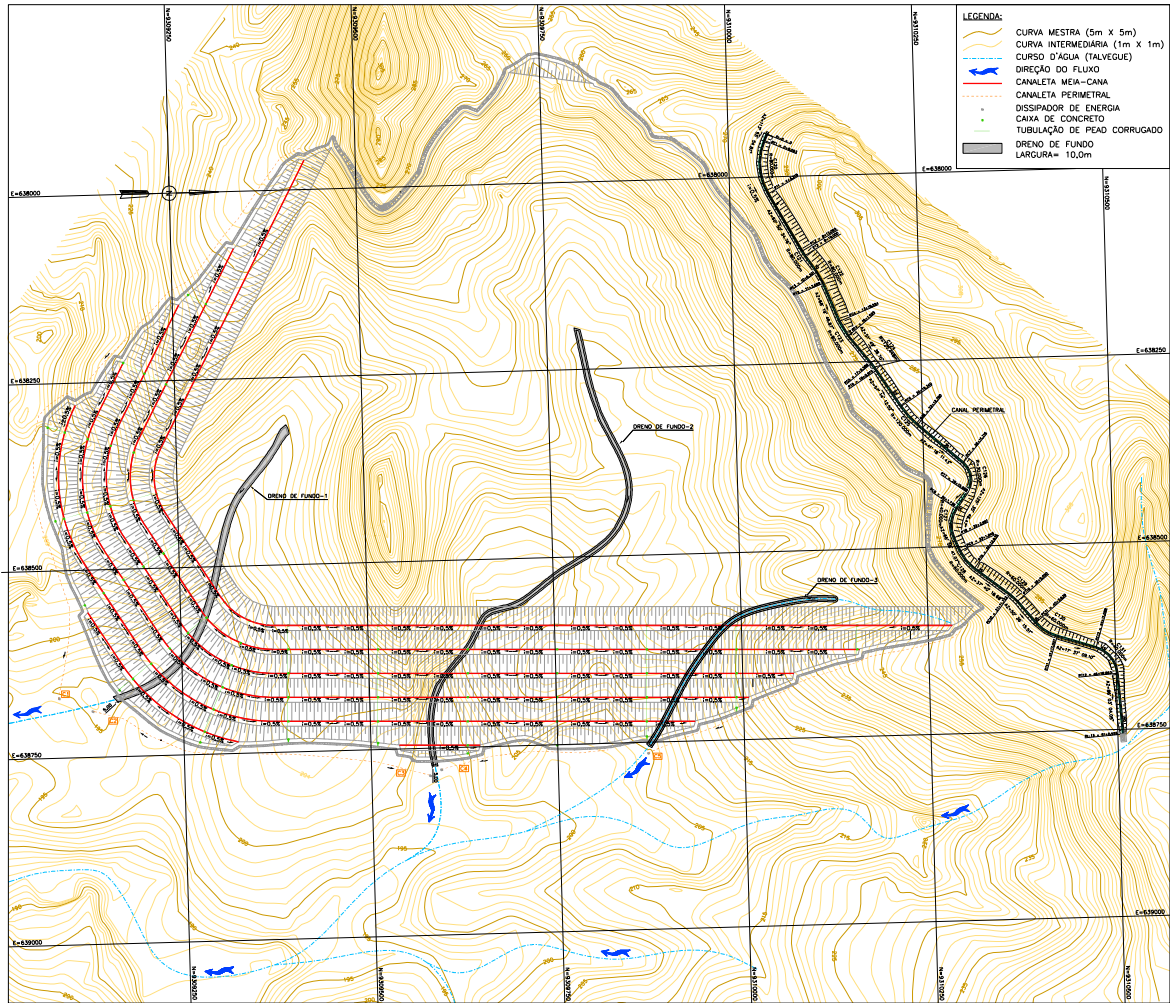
Pilha de Estéril e Sistema de Drenagem
